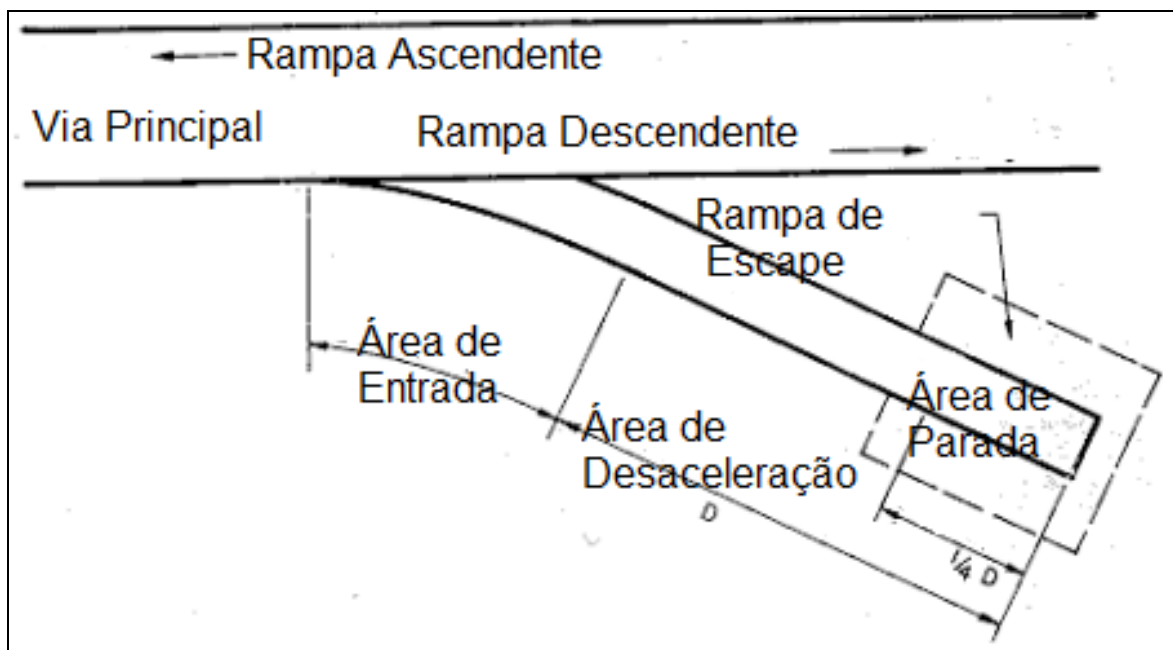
Estrada de Mina - Planta - Rampa de Escape Áreas: Entrada, Desaceleração e Parada.
